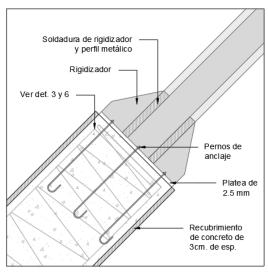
Anclaje de perfil metálico en brazo soporte de concreto
